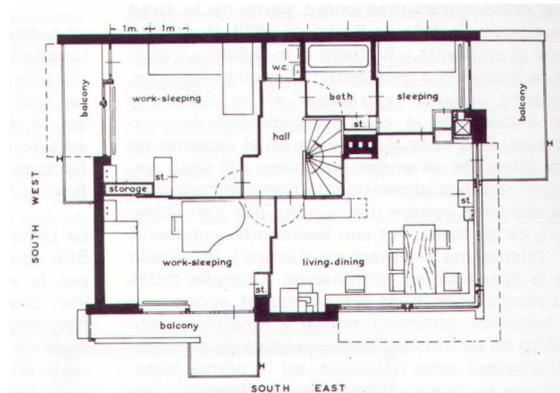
Schröder Haus - Grundriss - Wände Geschlossen
